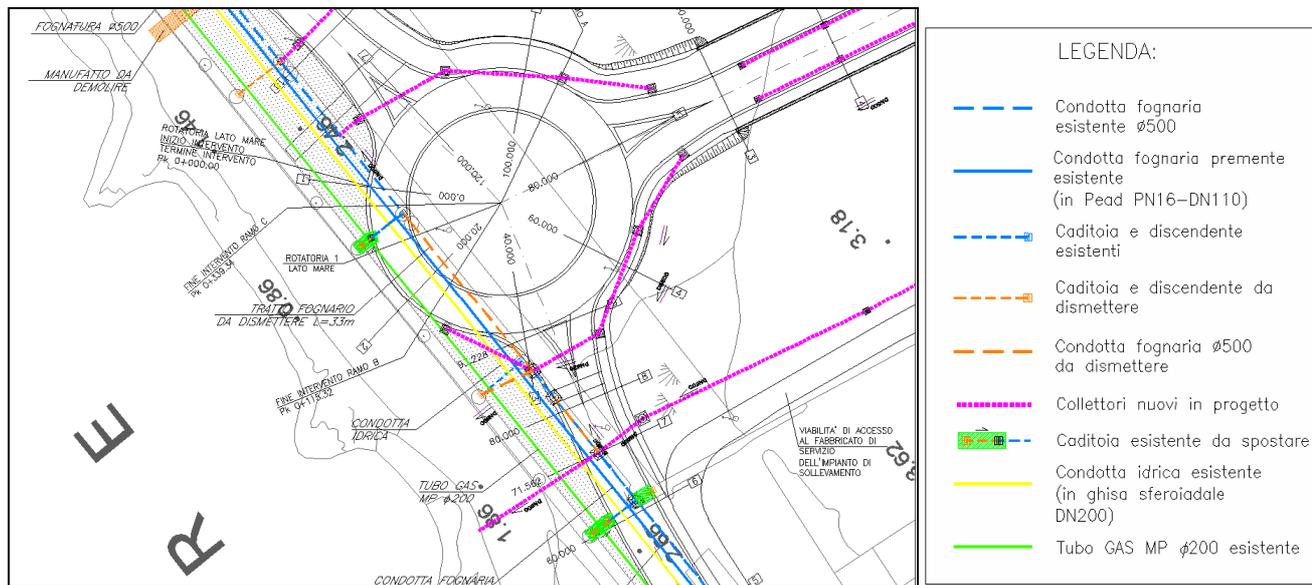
Stralcio planimetrico risoluzione interferenza fognaria
